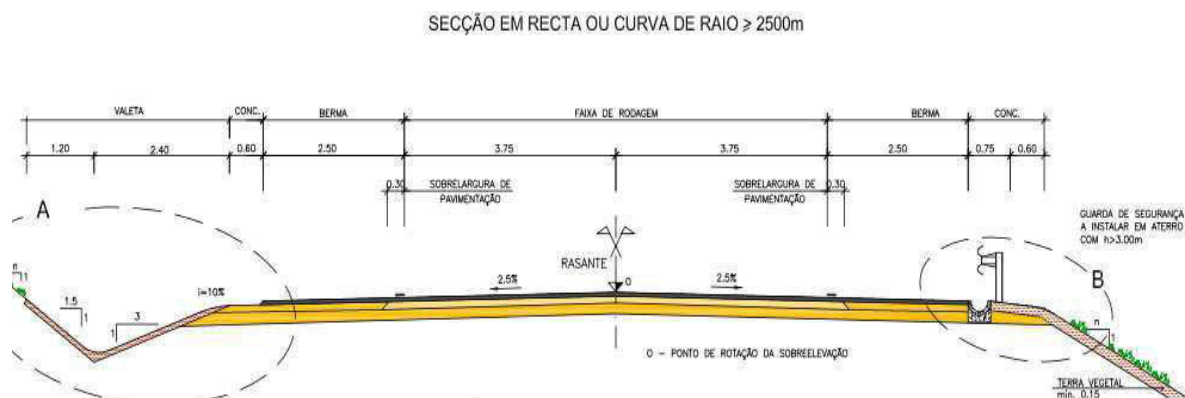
Perfil Transversal Tipo – seção corrente [3]
